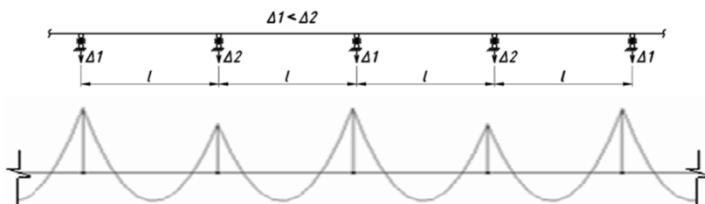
Расчетная схема и эпюра моментов неразрезной балки покрытия
